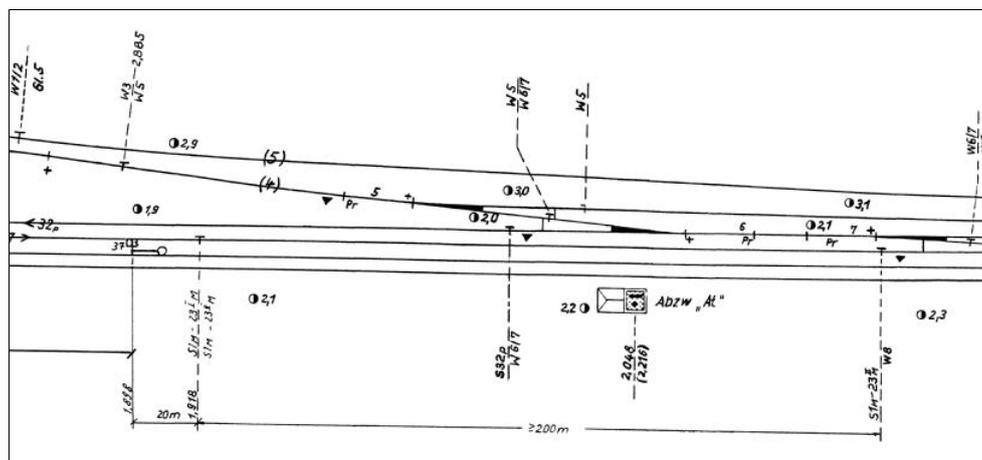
Sicherungstechnischer Lageplan (Auszug Abzw. „At“)
